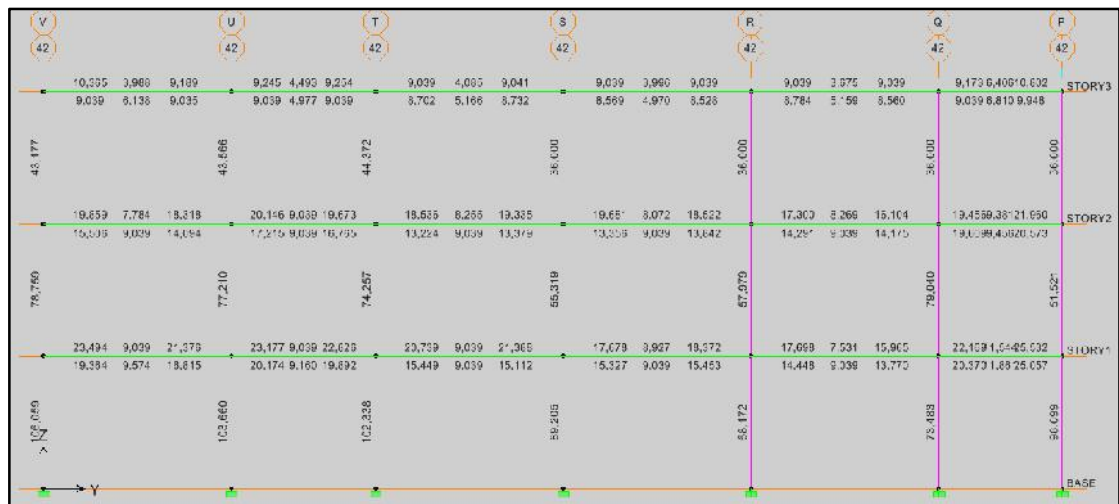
Acero en vigas pórtico 42, Consulta Externa I
